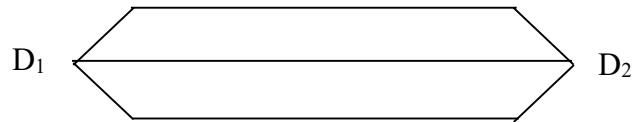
3 Potongan Memanjang Balok Anak Tipe BA1
